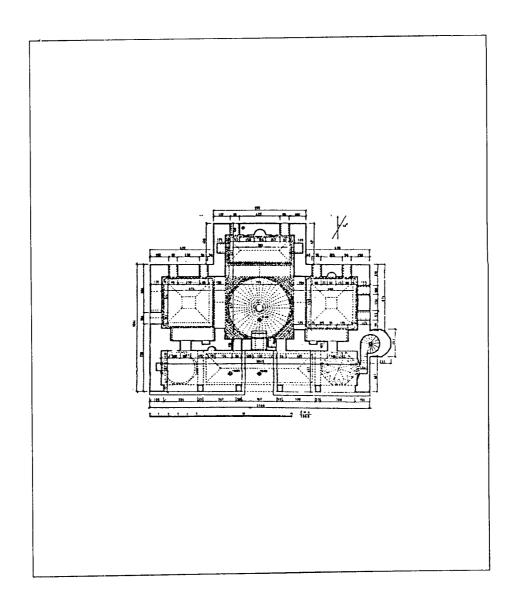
مسقط أفقي لمسجد البيلربي في أدرنة (عن: اصلان ابا)
